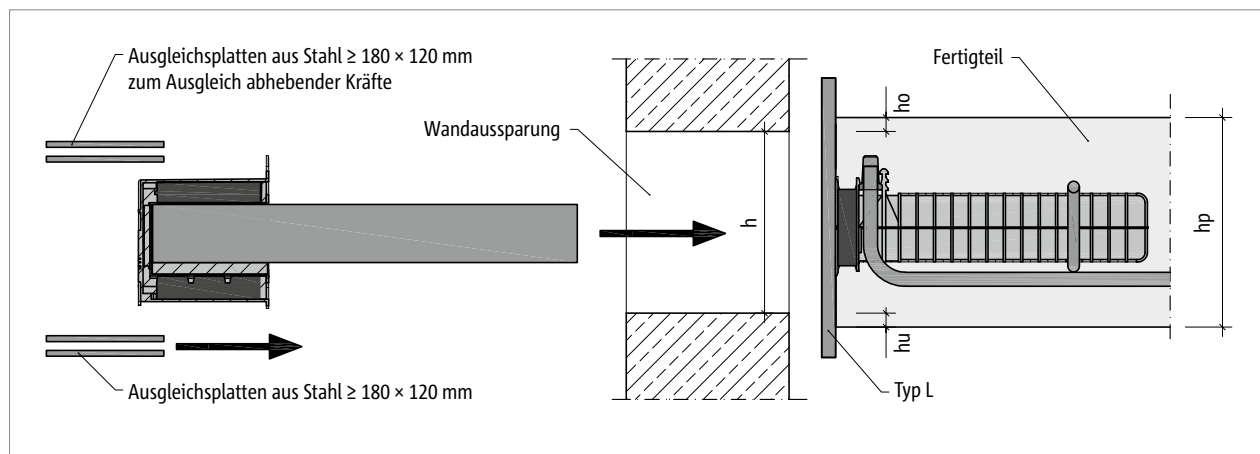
Tronsole® P: Wandaussparung bei Fertigteilbauweise
